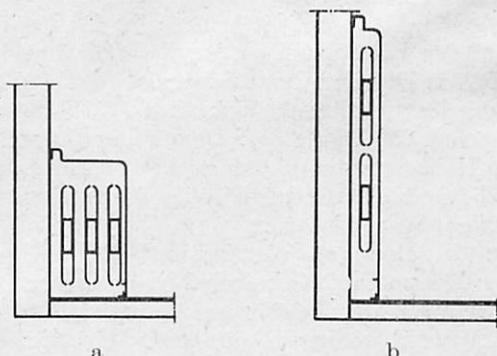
Zukünftige Ausführung mit wasserarmen Heizplatten.
